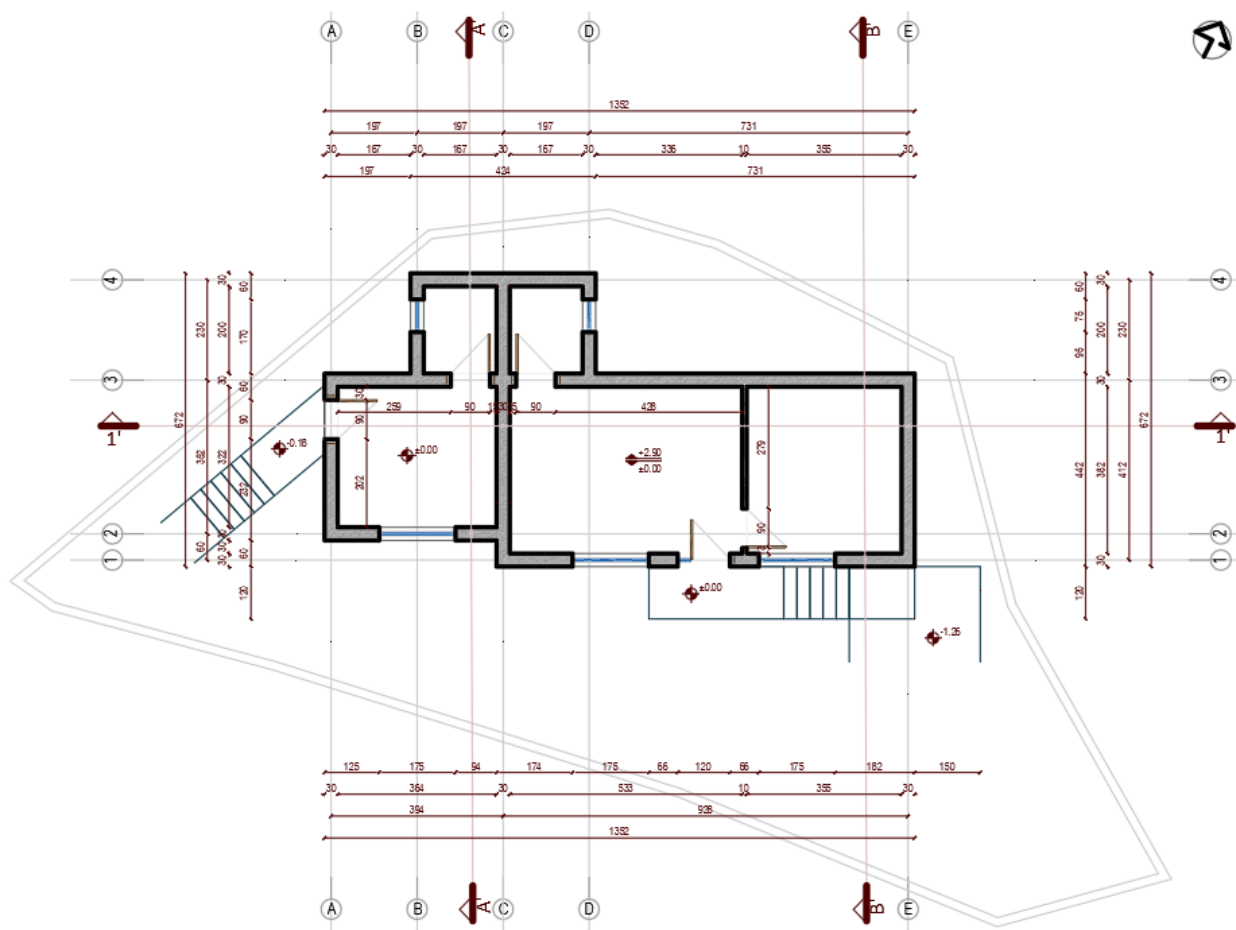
Planimetri kati 0 _ Kopshti publik Shelegar, Sarandë
